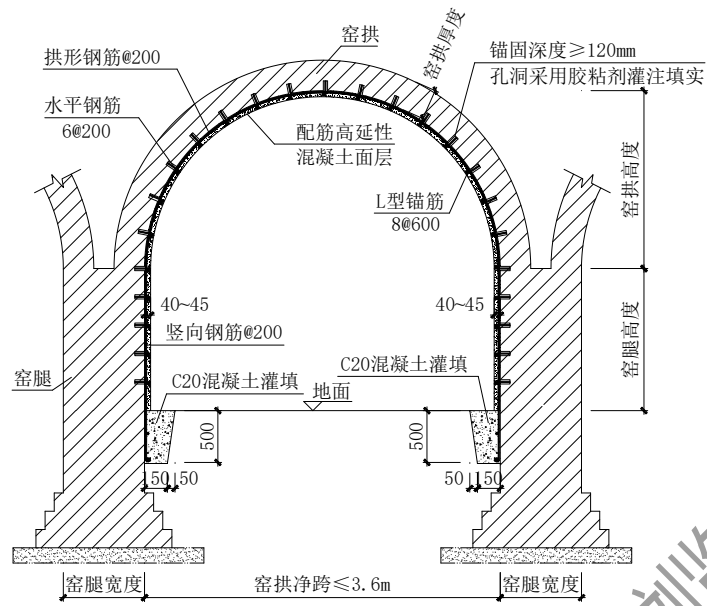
配筋高延性混凝土面层加固窑洞剖面示意图
